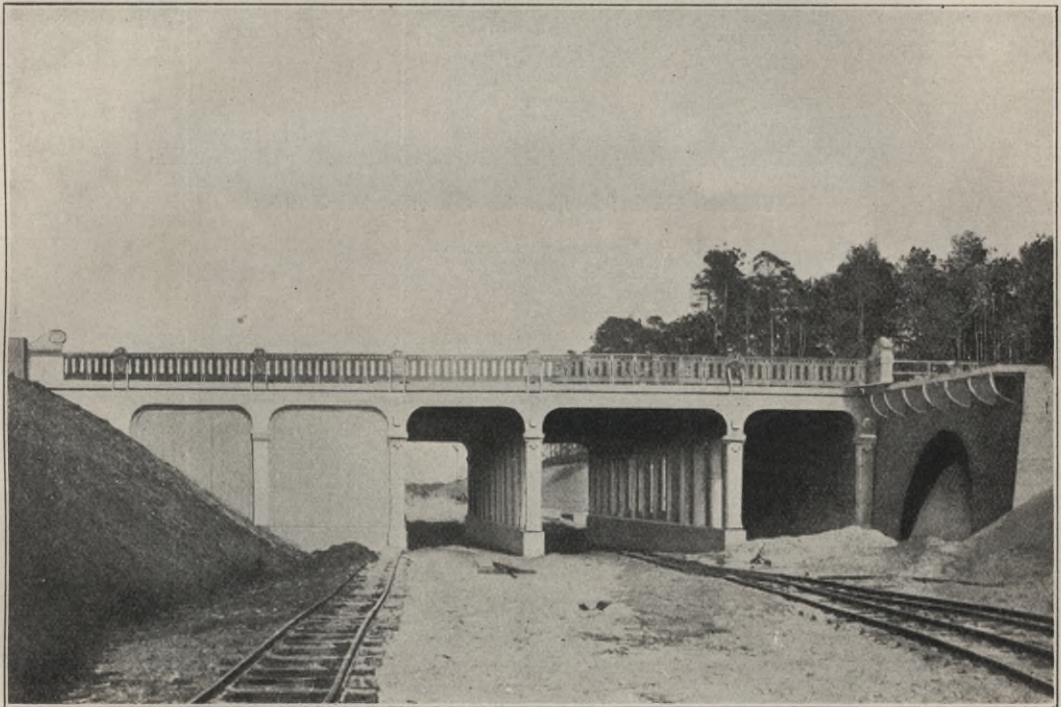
Eisenbetonbrücke Rennbahn im Grunewald.
